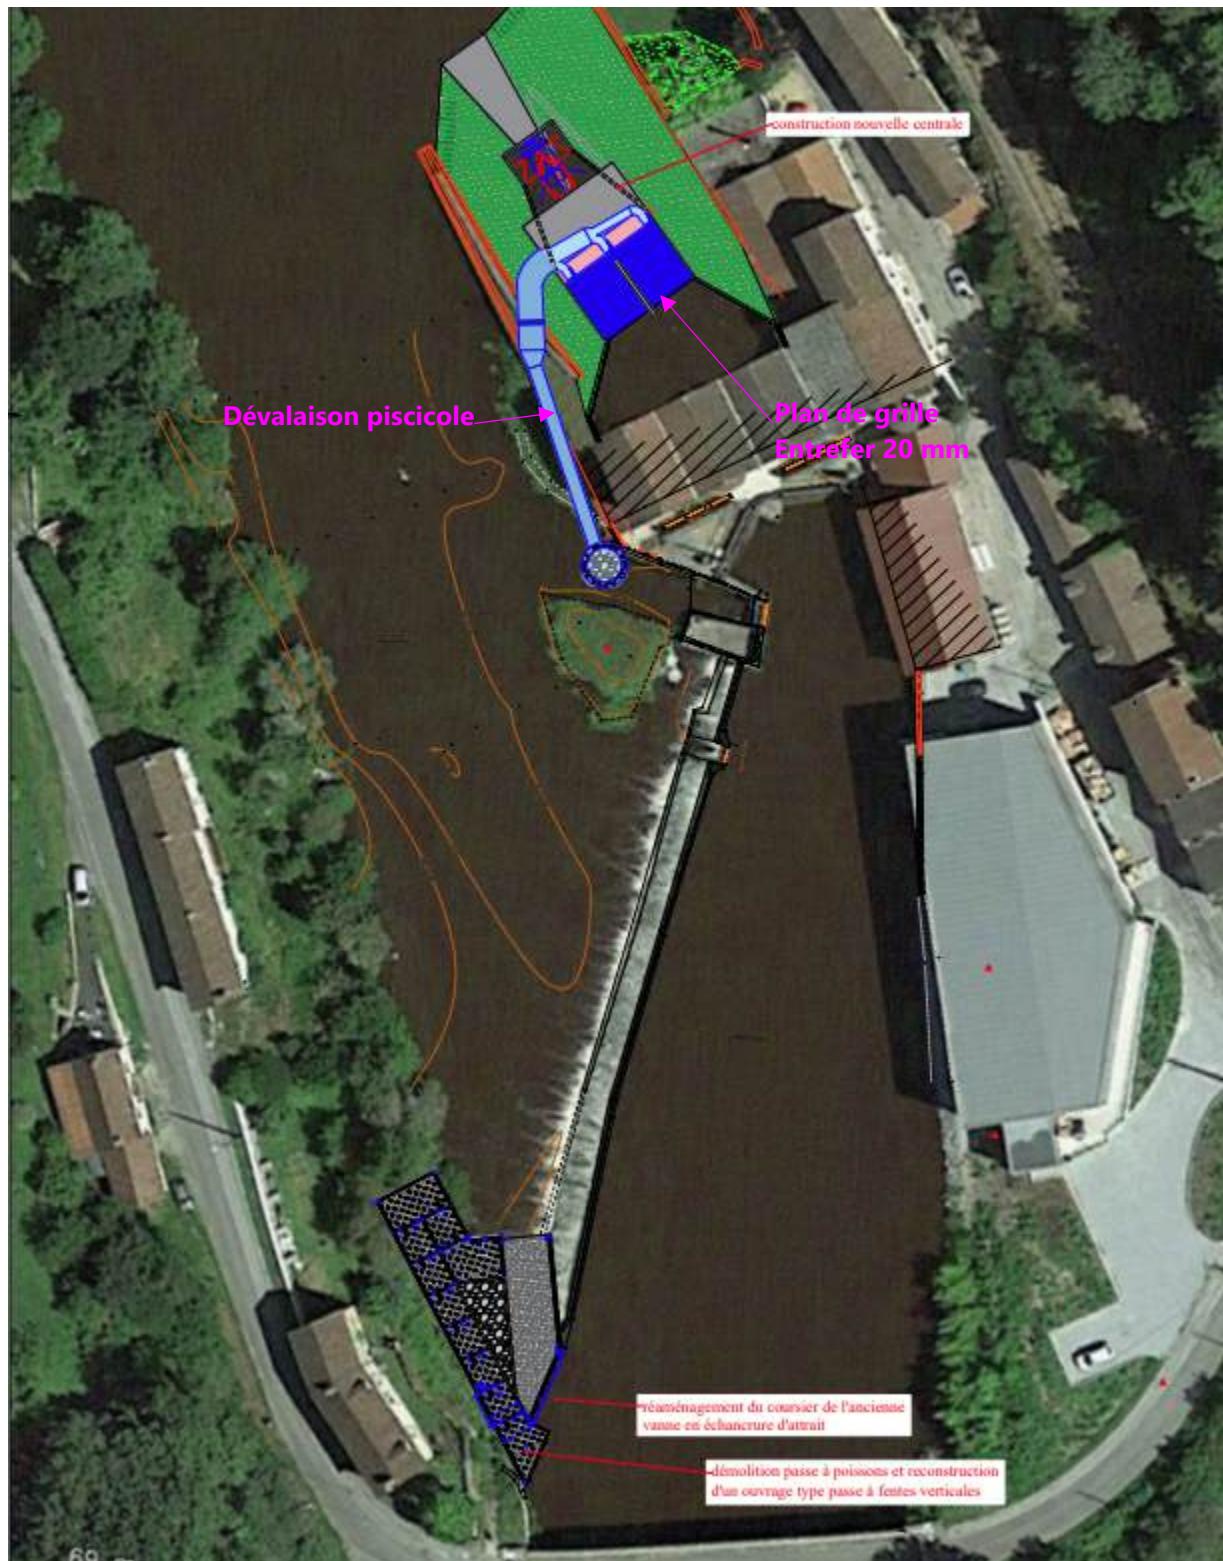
Plan des travaux au droit du barrage de l'usine de Brignac
